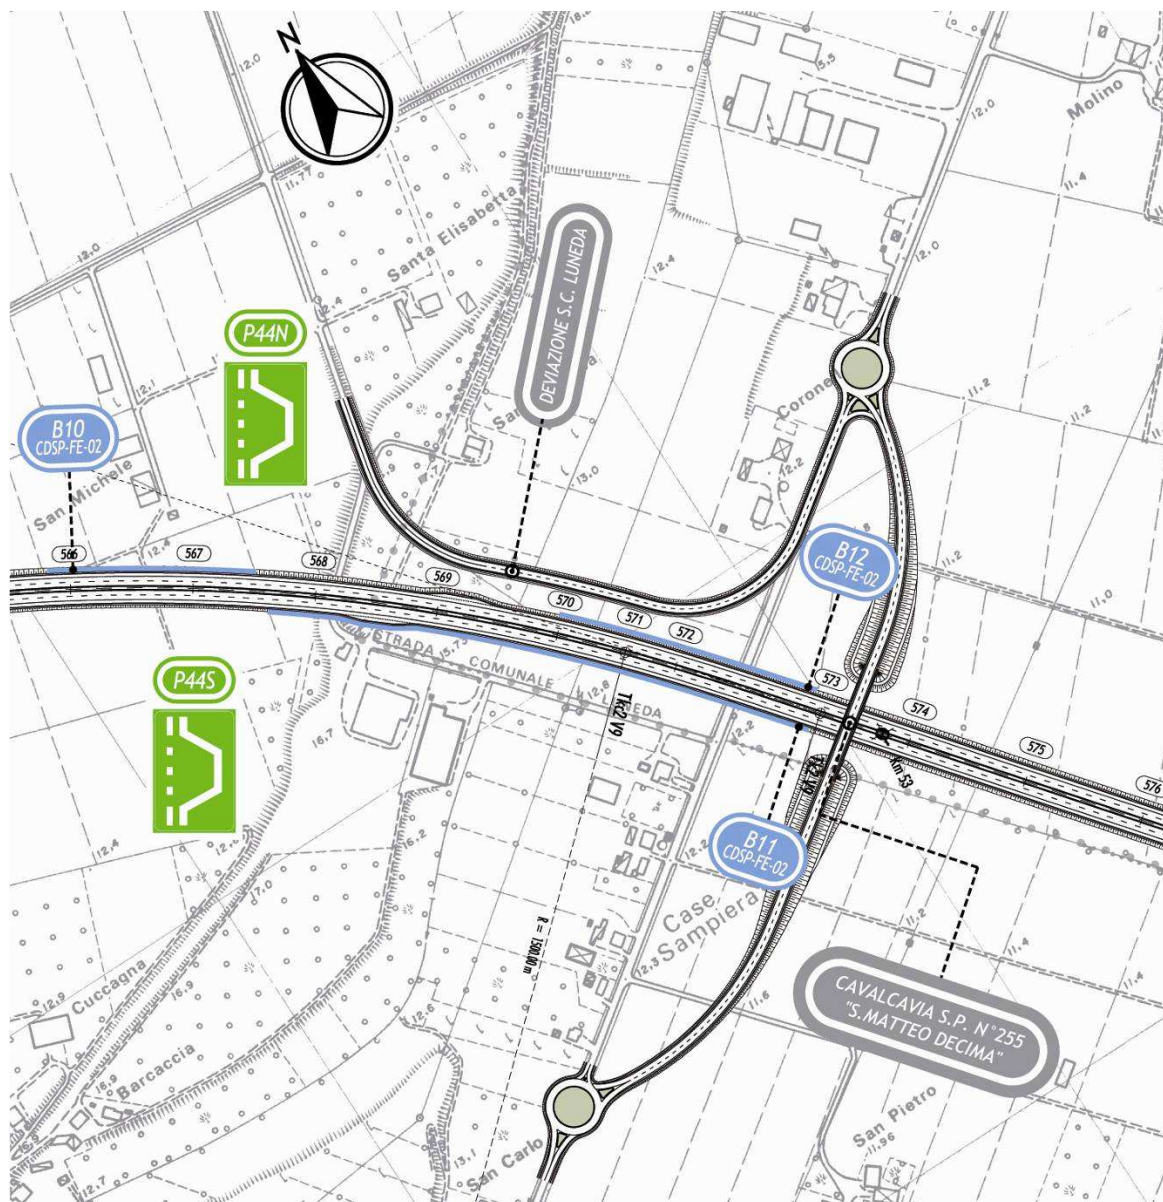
STRALCIO PLANIMETRICO STRADA COMUNALE LUNEDA
